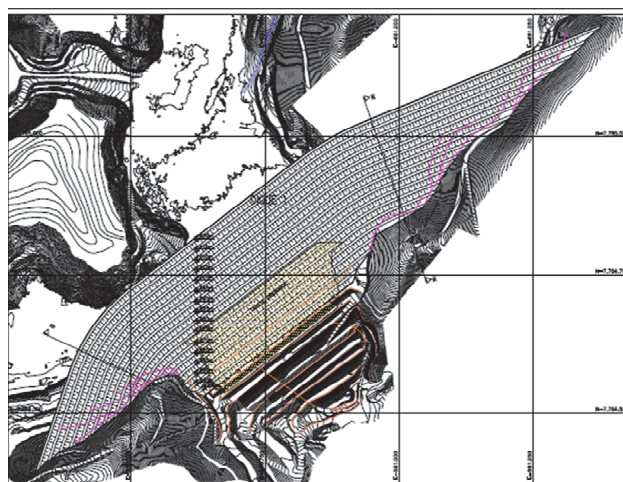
Vista em planta do projeto da Barragem de Fundão em 2011, ainda à meia altura.
